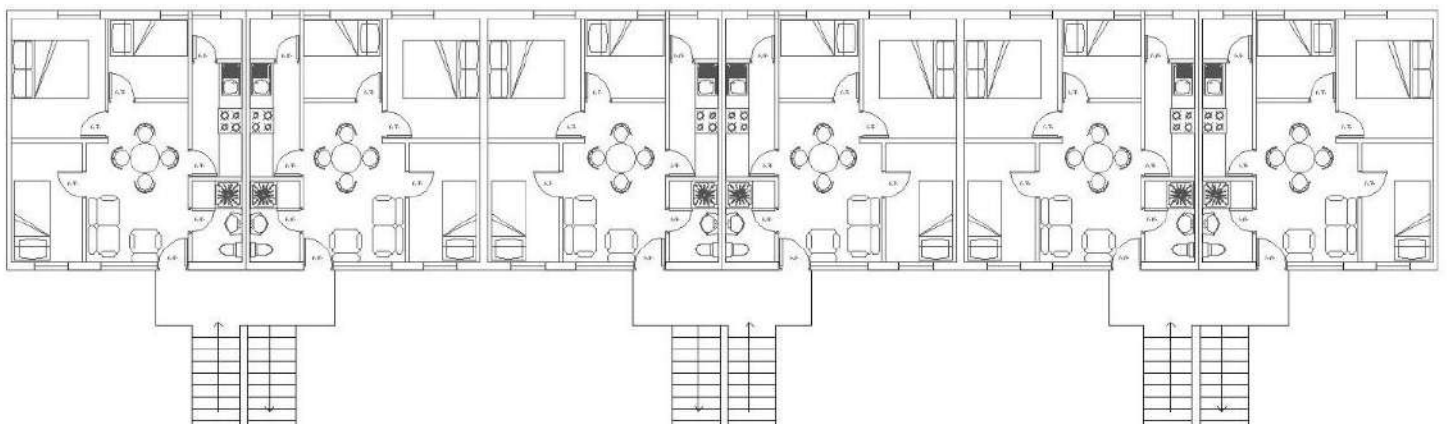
Planta Arquitectónica. Fuente: Elaboración propia.
